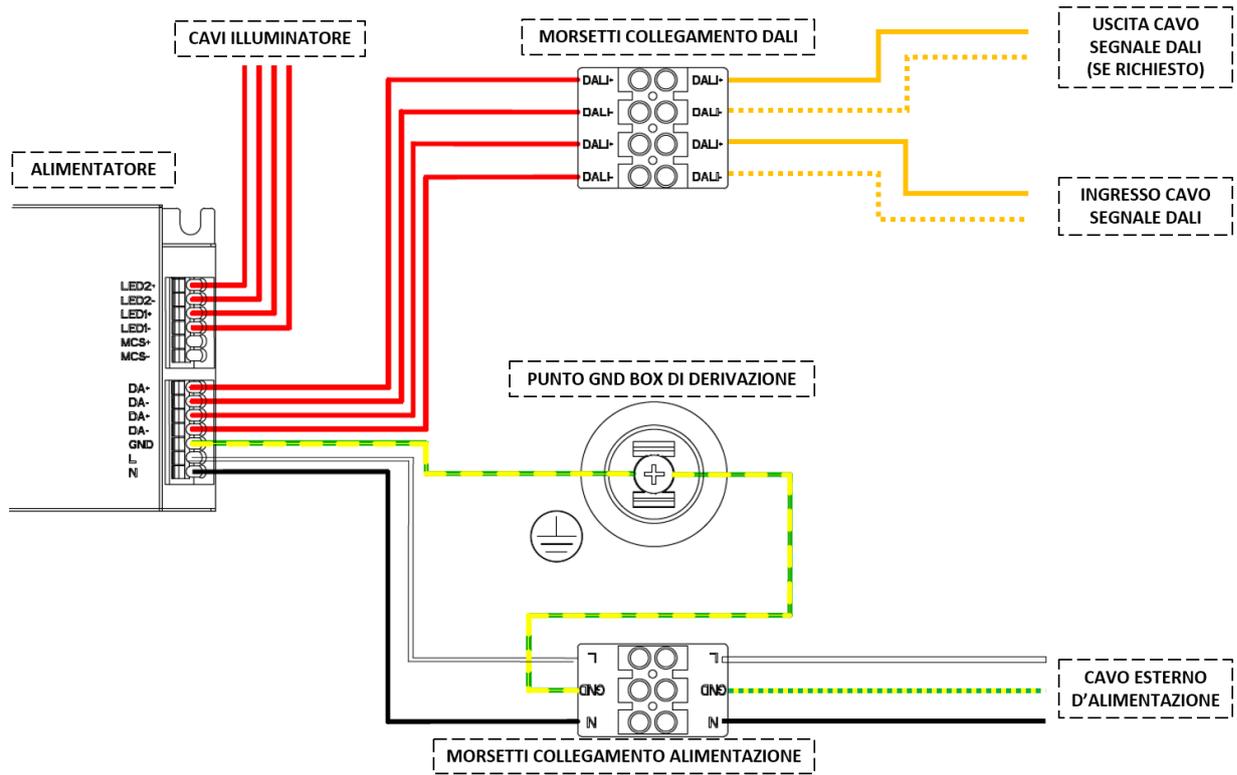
Schema dei collegamenti elettrici con il cablaggio esterno d'alimentazione e DALI.
